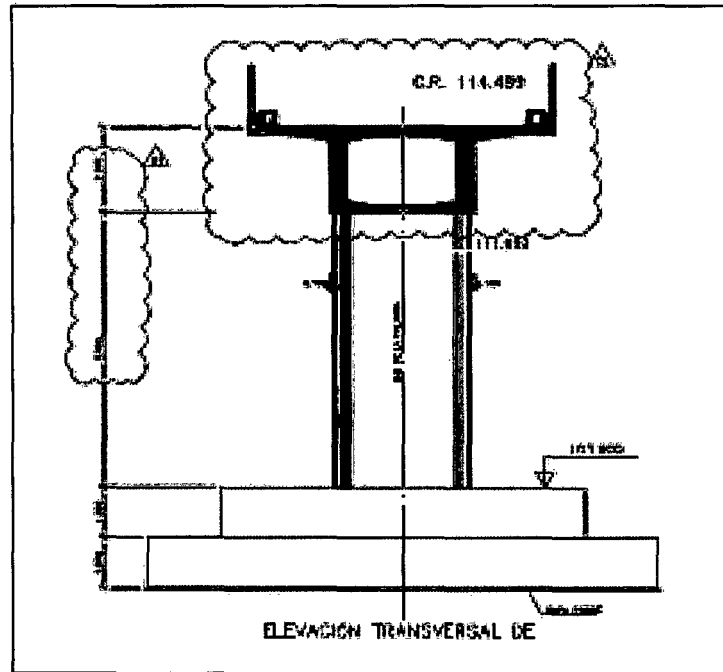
Sección transversal de la columna y zapata del tramo curvo
